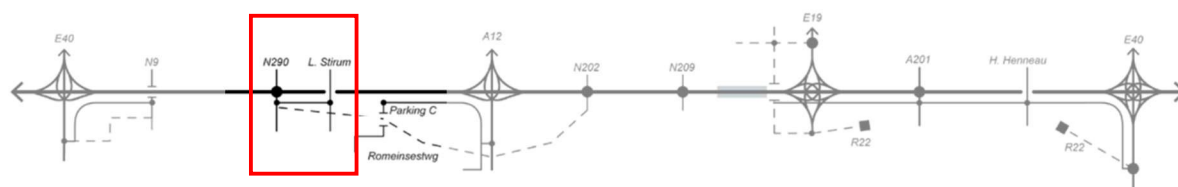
Schéma linéaire G3A2 variante profil longitudinal réduit/pont paysager maximal Wemmel-Jette (depuis la N290 à l'Avenue De Limburg Stirum)
